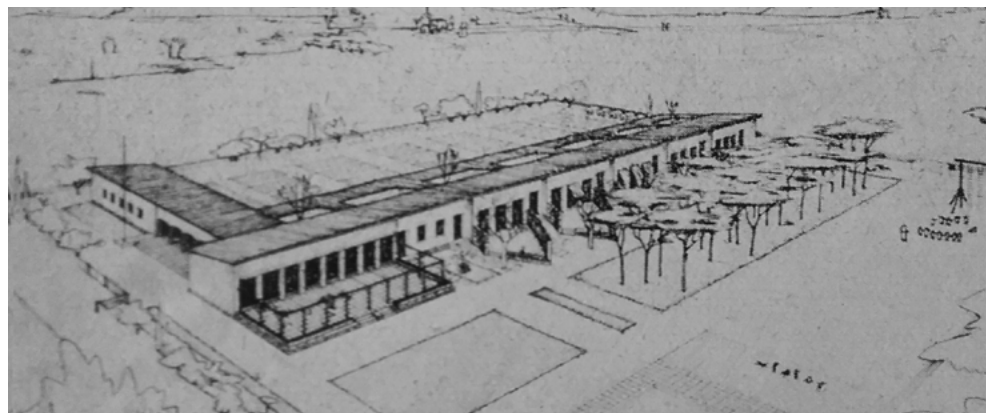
Schizzo prospettico d'insieme; fonte: MORETTI, 1942
